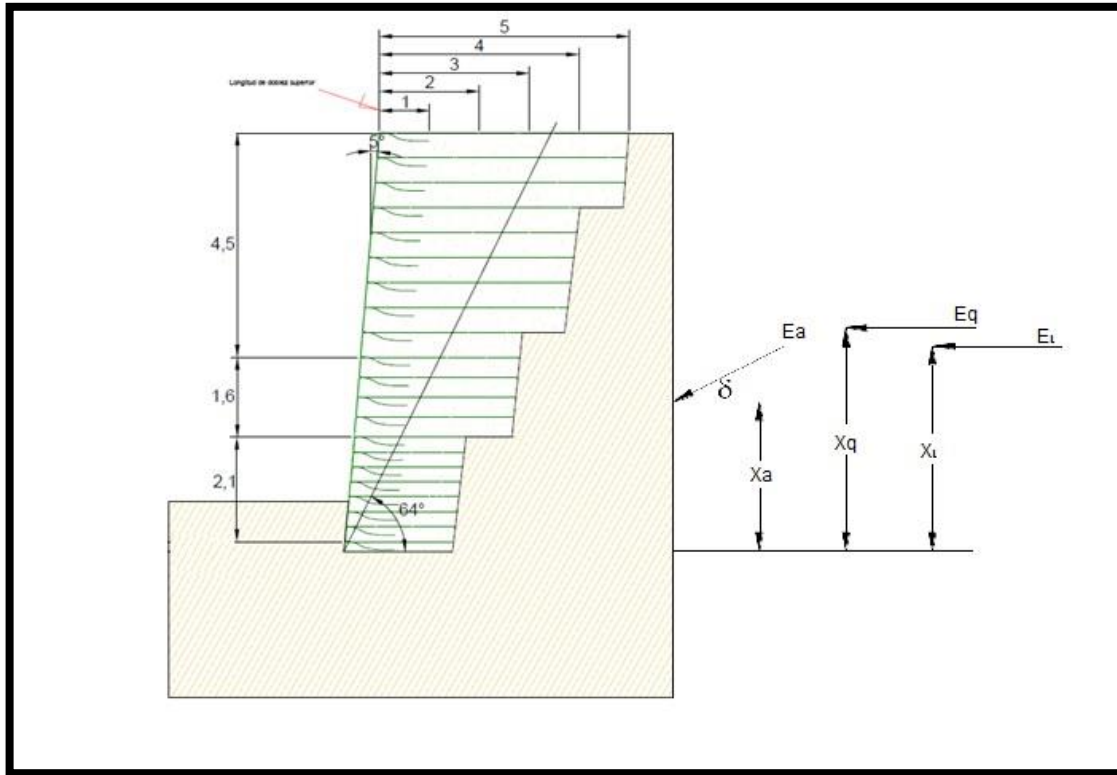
Fuerzas que actúan en un muro reforzado con geotextiles
